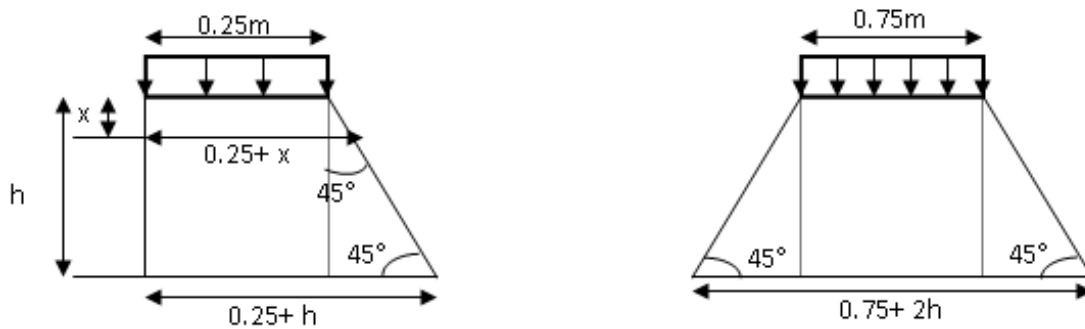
Poussée de la charge locale située en arrière de mur
